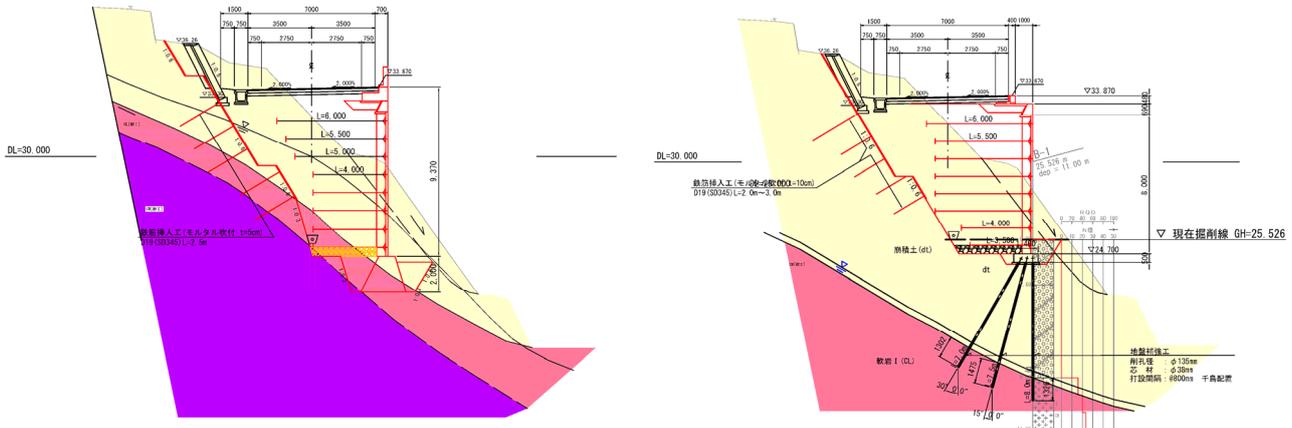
代表断面図対比（左：当初計画断面図 右：変更計画断面図）
